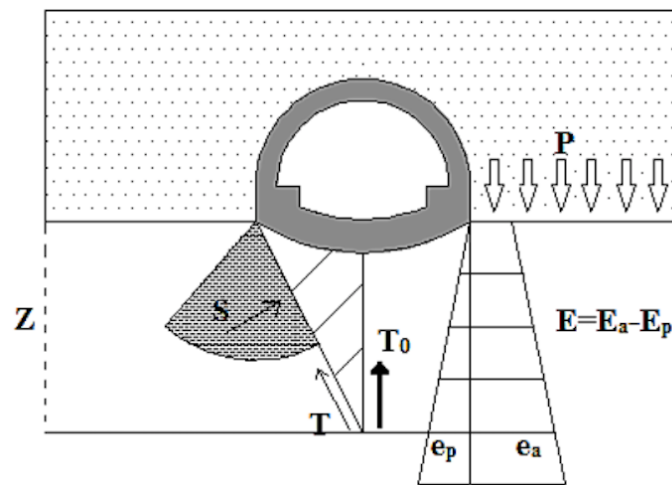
La poussée au niveau du radier selon TSIMBARIÉVITCH
